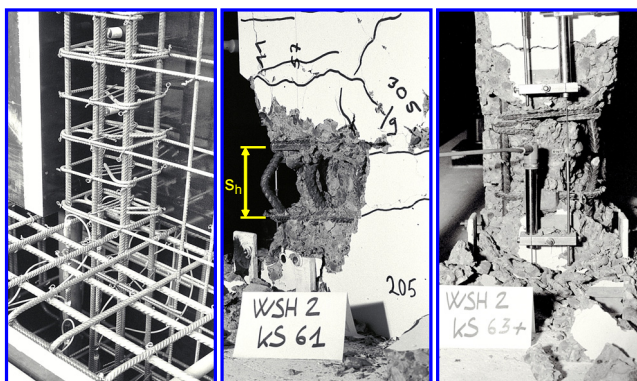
Ungenügende Anordnung der Stabilisierungsbewehrung im plastischen Bereich einer Stahlbetontragwand
